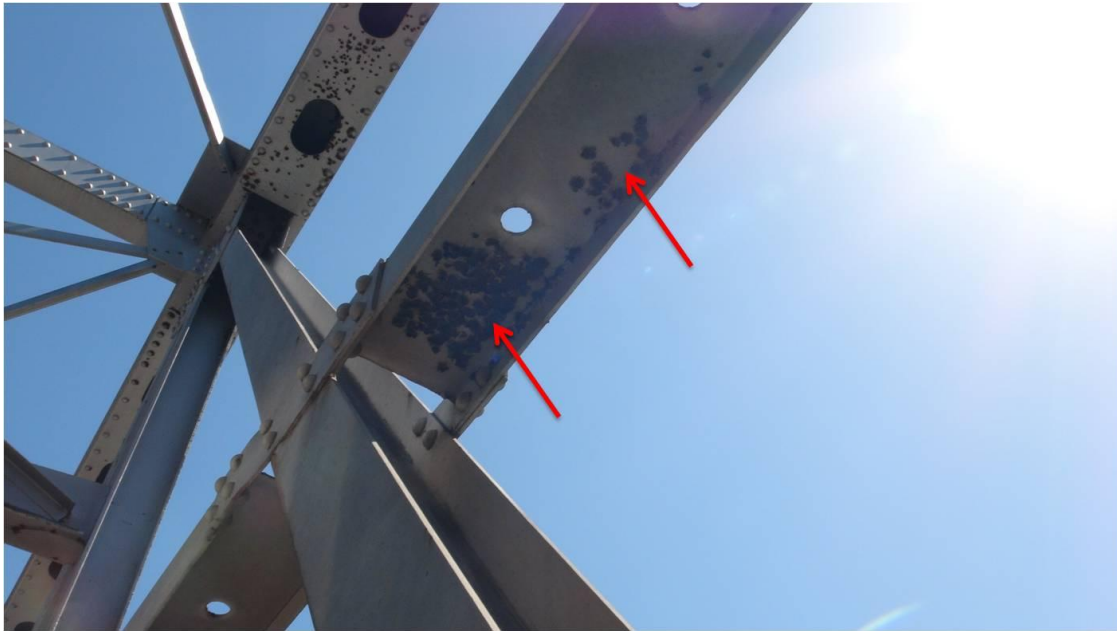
Piquetes de corrosión en vigas transversales y arriostres inferiores entre armaduras.
